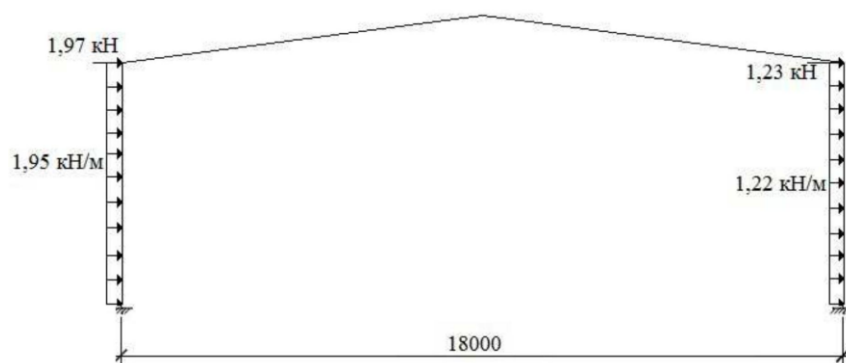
Схема навантаження від вітрового навантаження зліва будівлі
